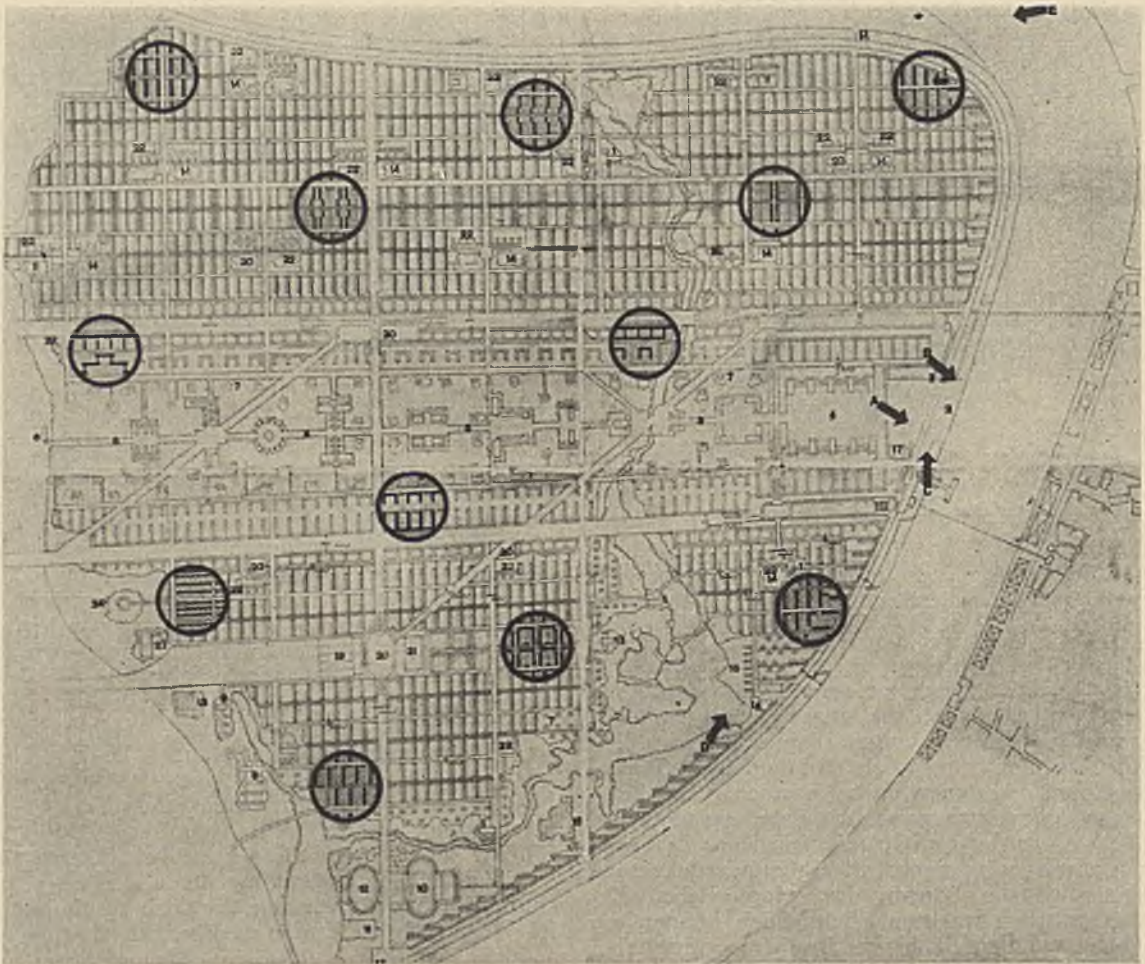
Lageplan mit Darstellung verschiedener Bauungsmöglichkeiten innerhalb des gleichen Straßennetzes.
